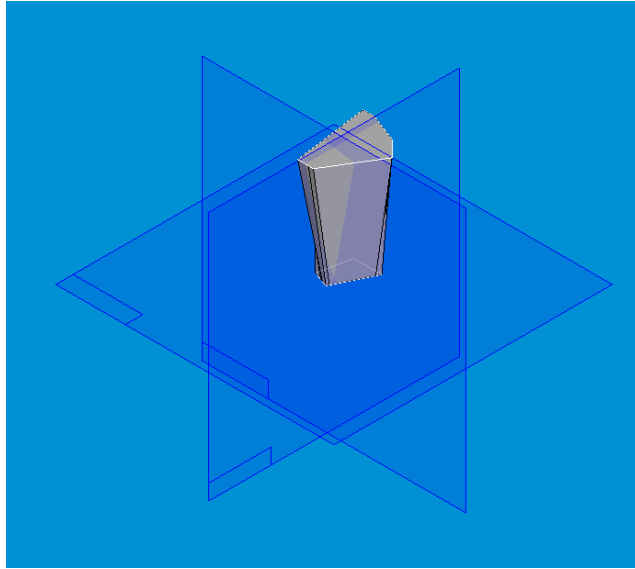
Ricostruzione geometrica del pilastro 25.
